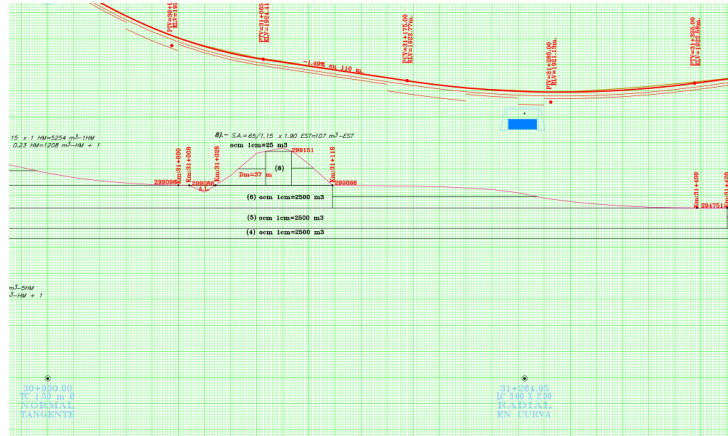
Ubicación y Tipo de Drenaje en el Perfil de Trabajo
